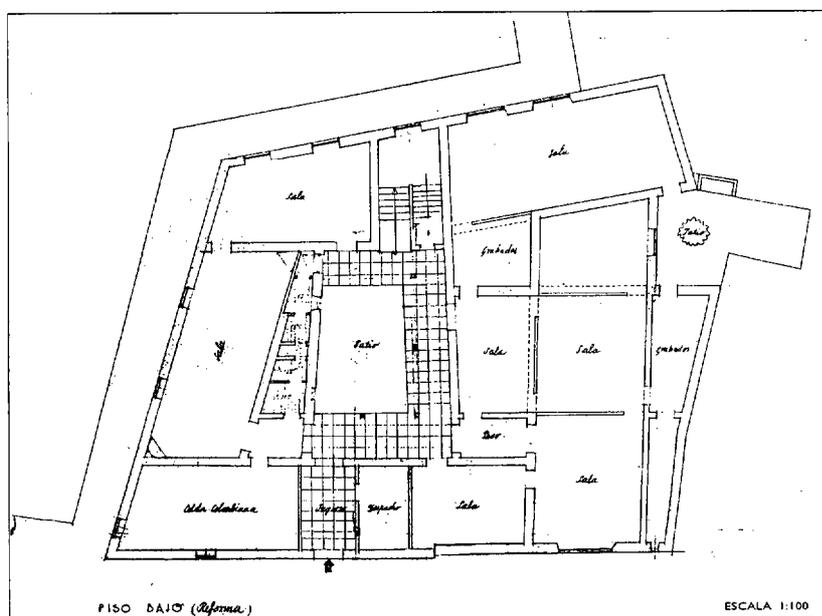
S. ZUAZO: Anteproyecto. Planta baja.
